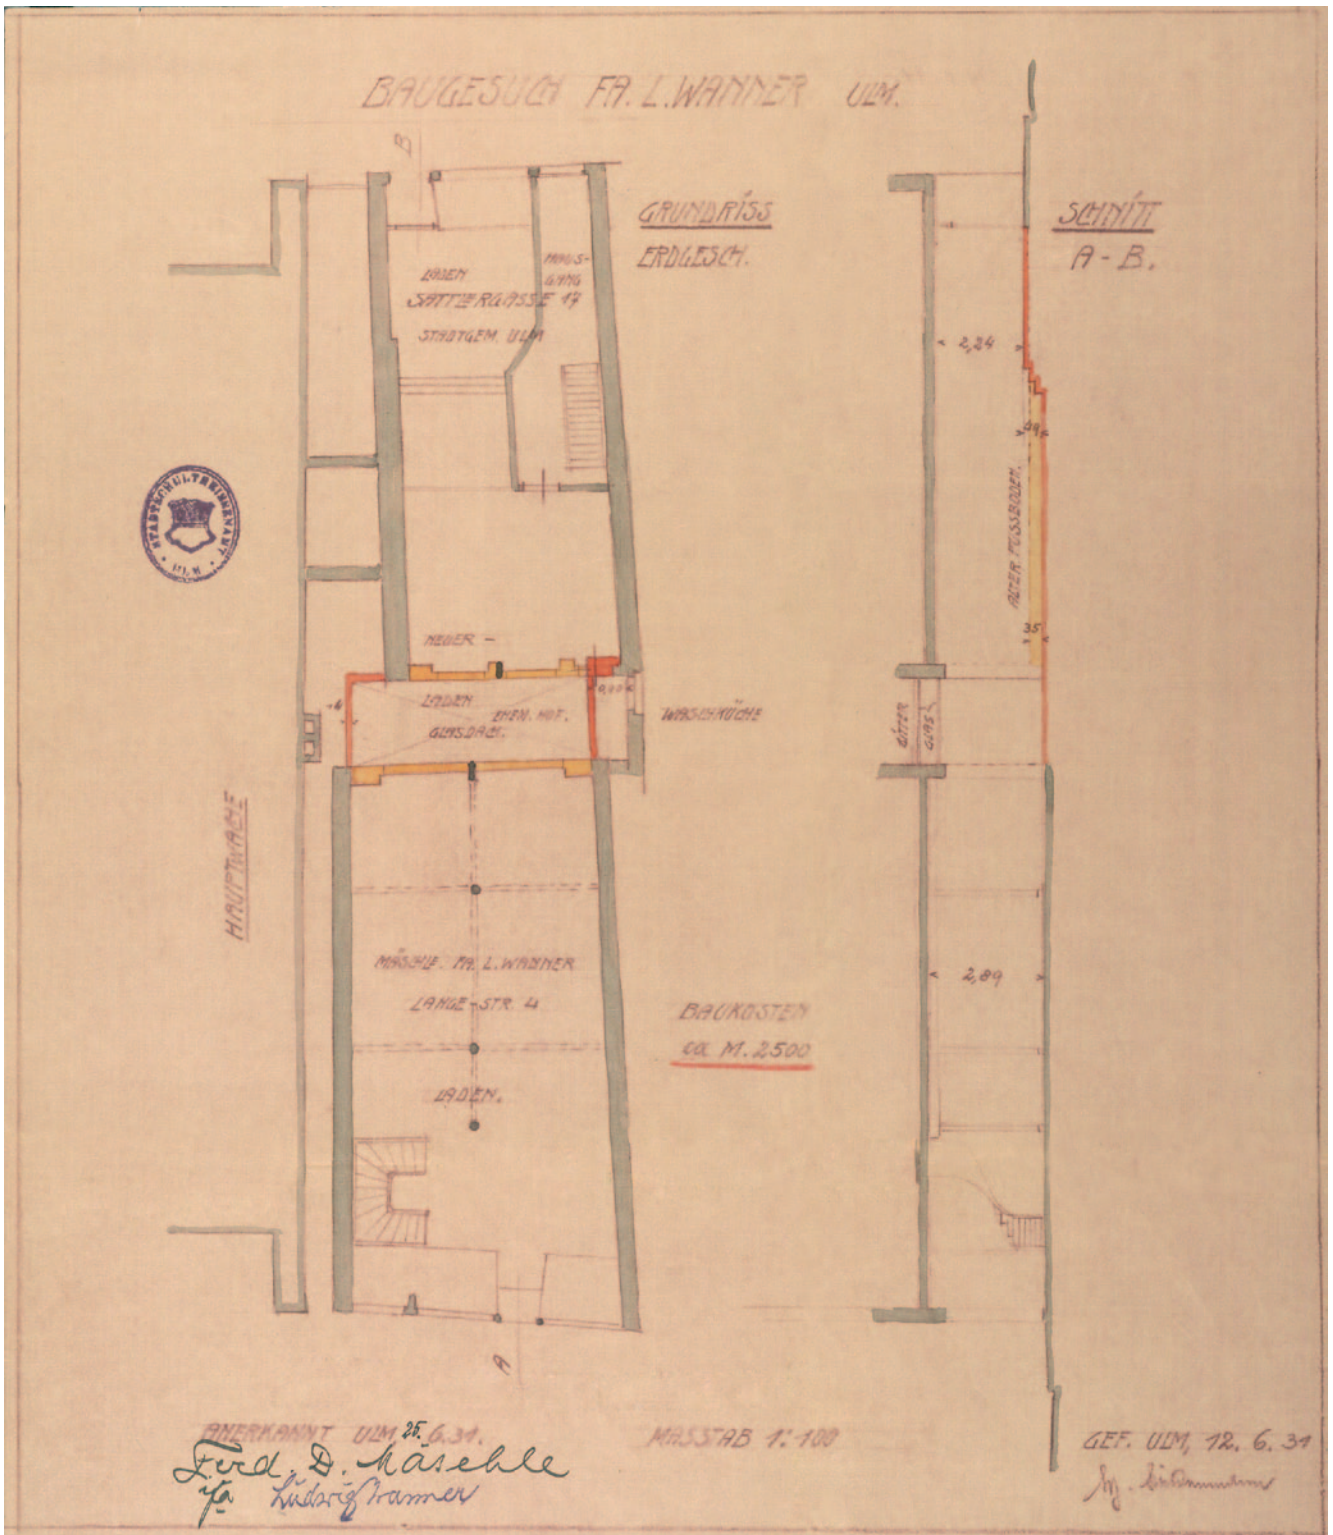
Gebäude Lange Straße 4 (A 183) und Sattlergasse 17 (A 159), Erdgeschossgrundriss, Baugesuch 1931.
